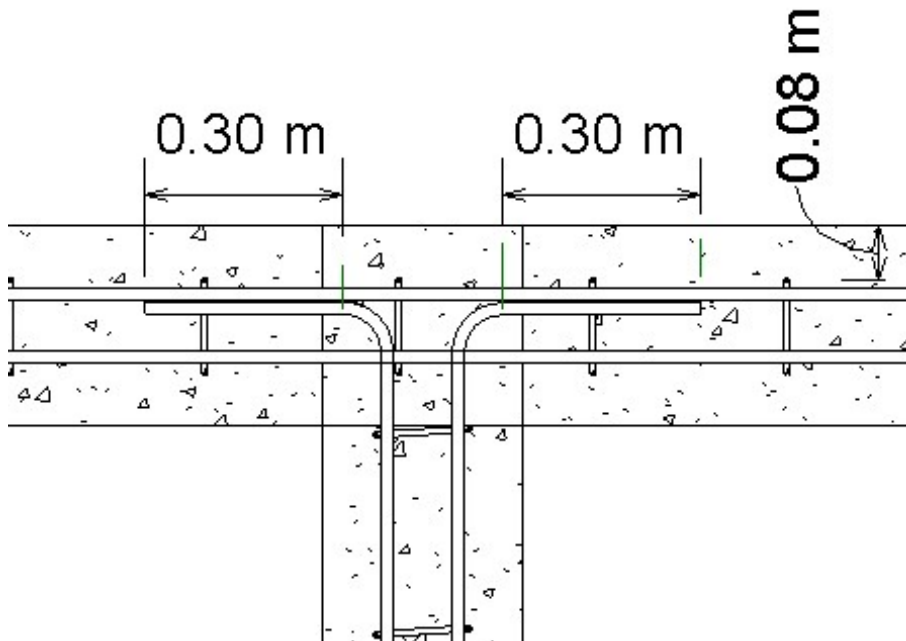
Detalle del nudo de losa y muro intermedio de alcantarilla de una celda.
